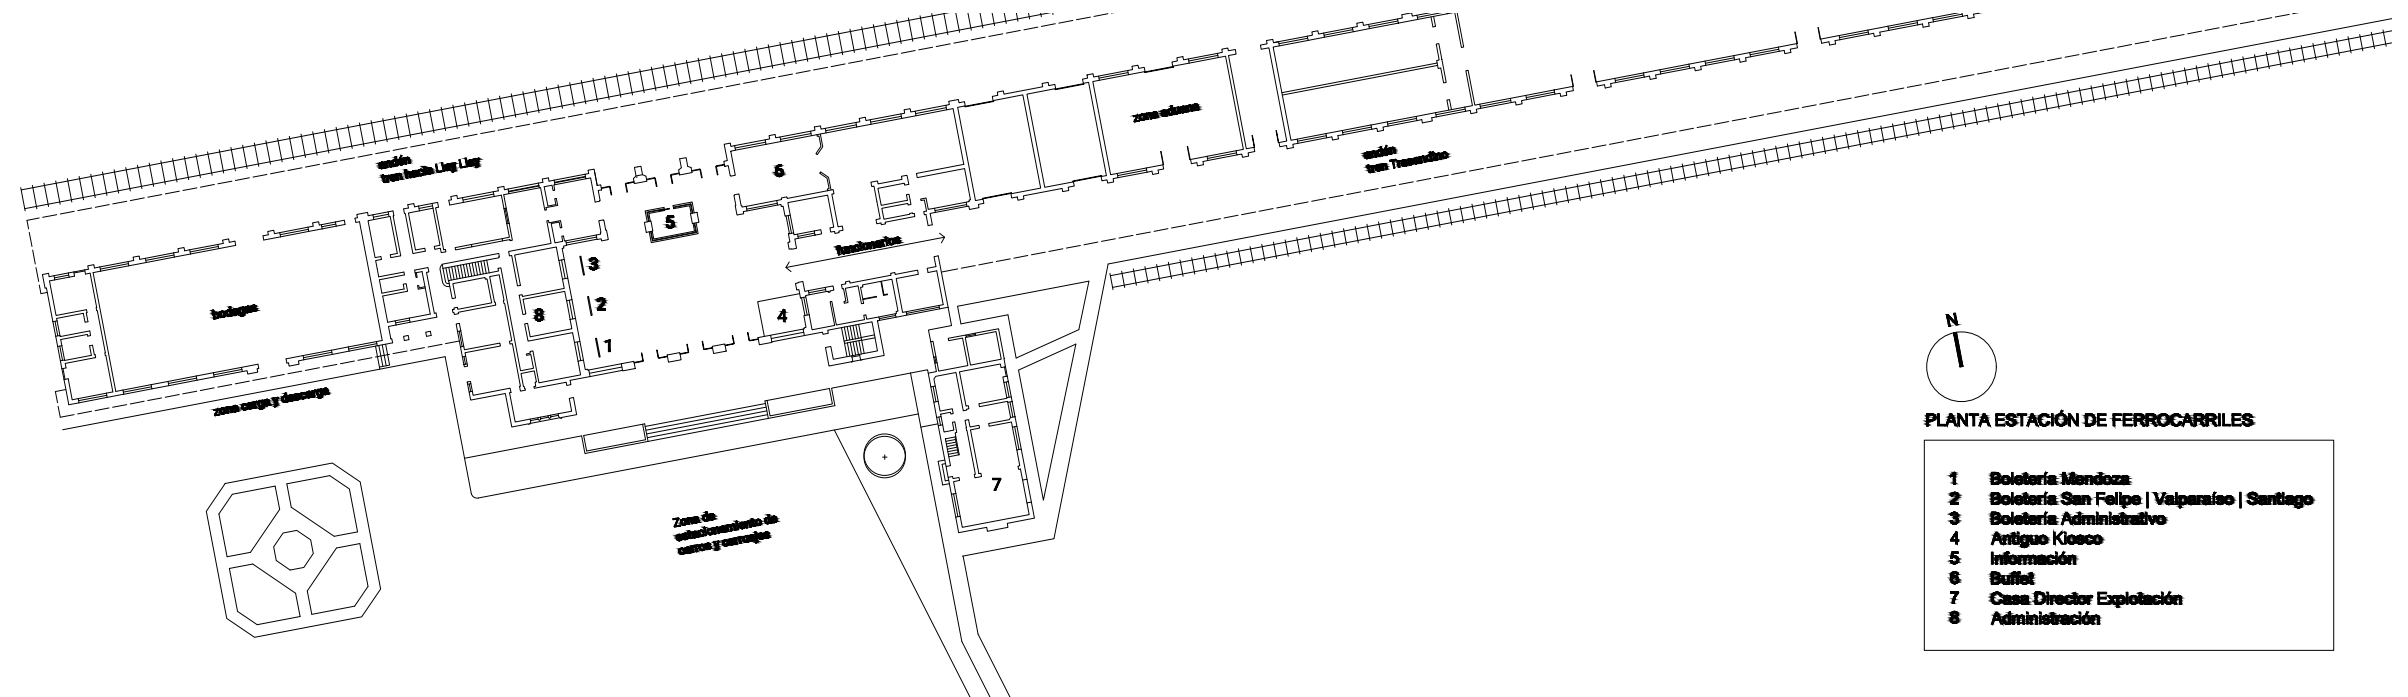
Plano de la estación Ferroviaria Construida en 1954.
